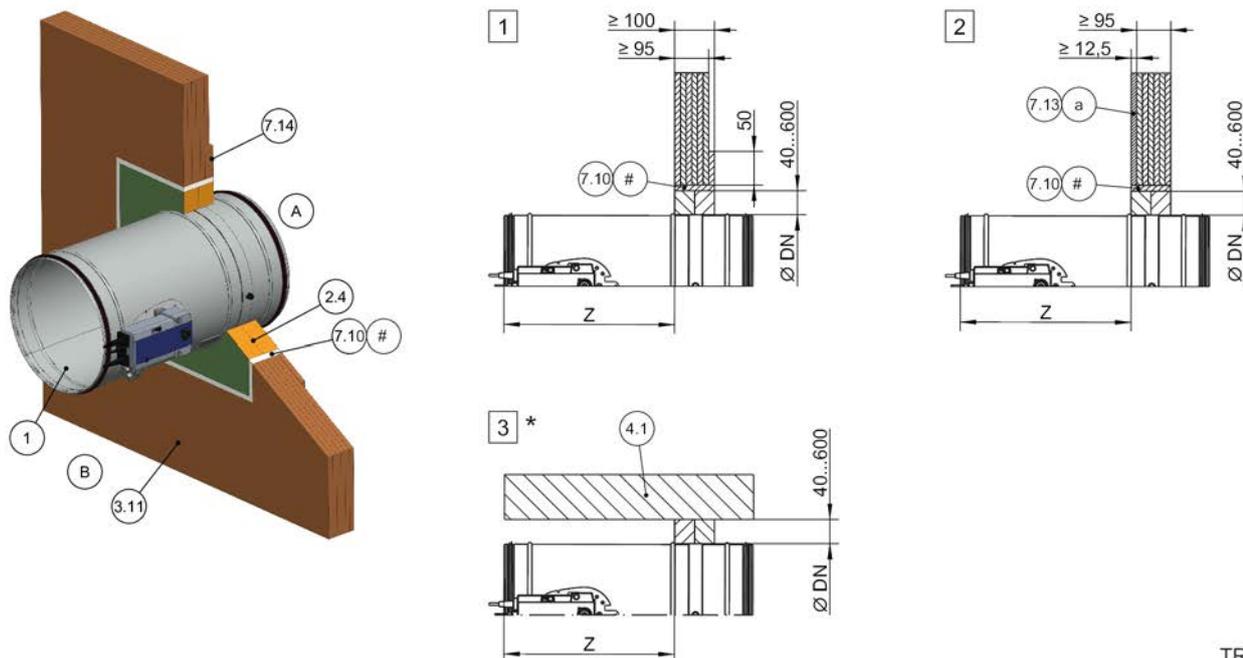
Montagem seca em parede de madeira maciça ou parede de madeira laminada cruzada, com kit de montagem TQ
